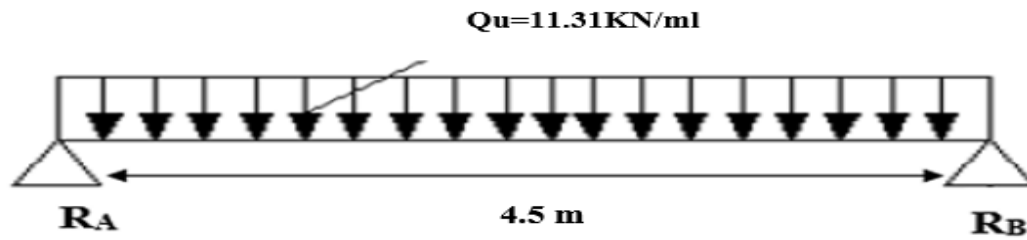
schéma statique de la poutre chaînage à l'ELU
